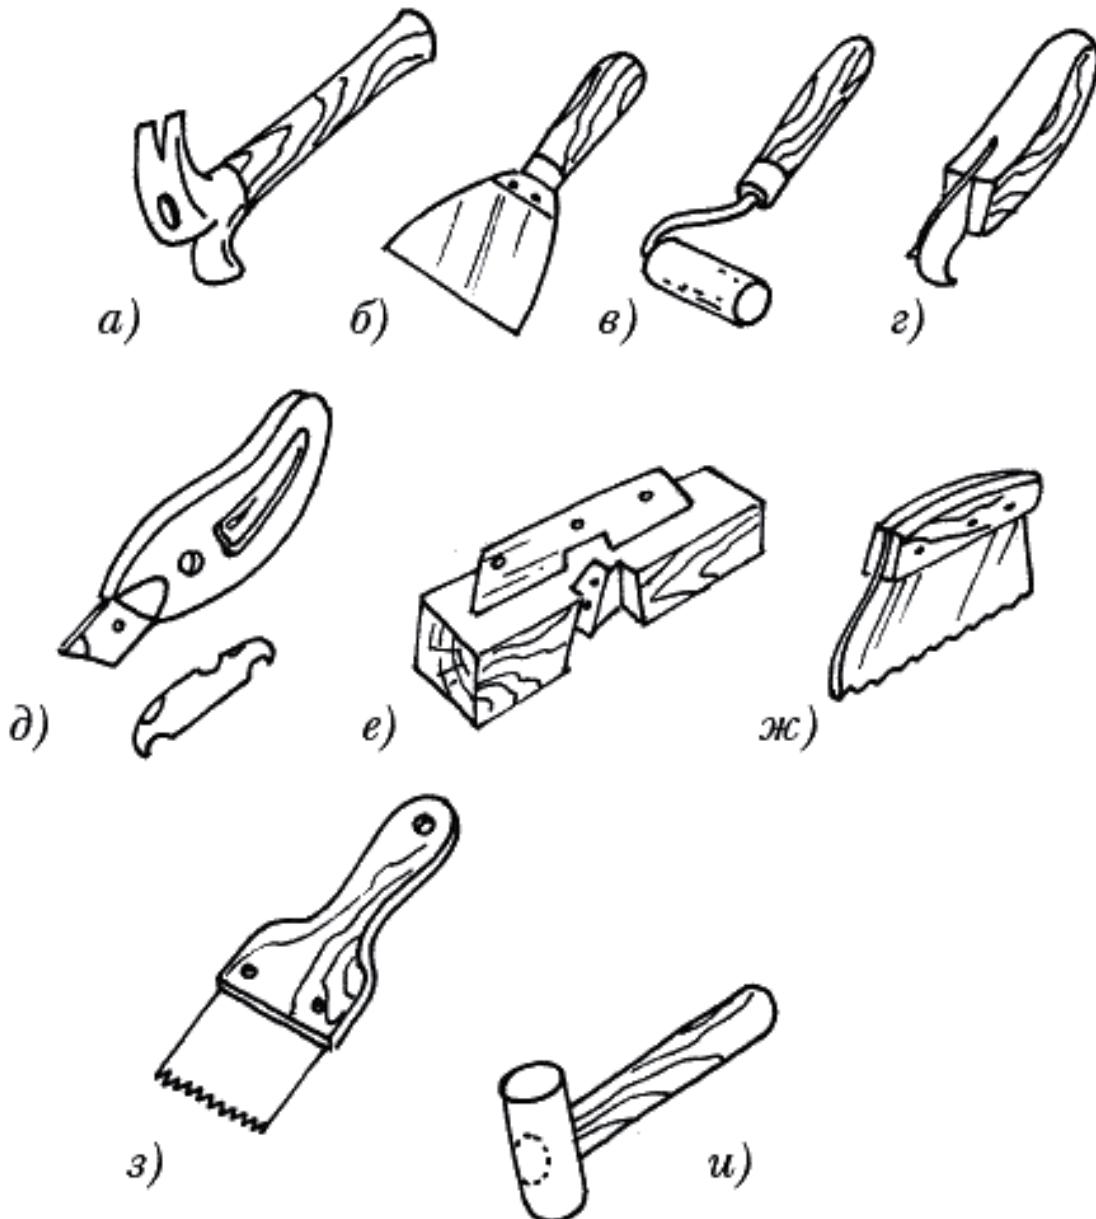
Инструменты для укладки линолеума: а) металлический молоток; б) стальной шпатель; в) линолеумный валик; г) линолеумный нож; д) приспособление для прирезки кромок линолеума; е) большой зубчатый шпатель; ж) линолеумный нож со сменными лезвиями; з) малый зубчатый шпатель; и) деревянный молоток
